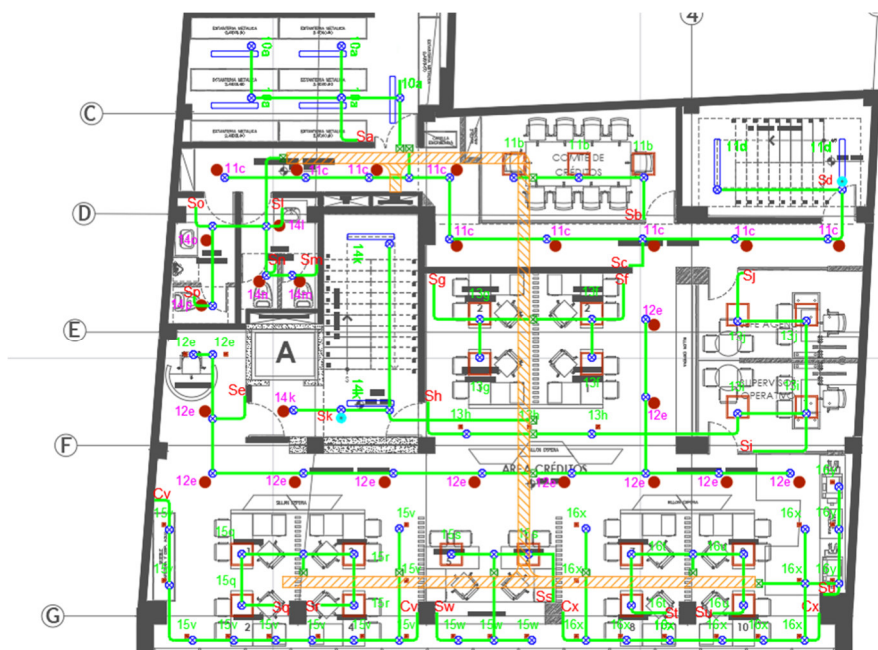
Detalle ejemplo de Distribución de Salidas de Iluminación en Planta.
